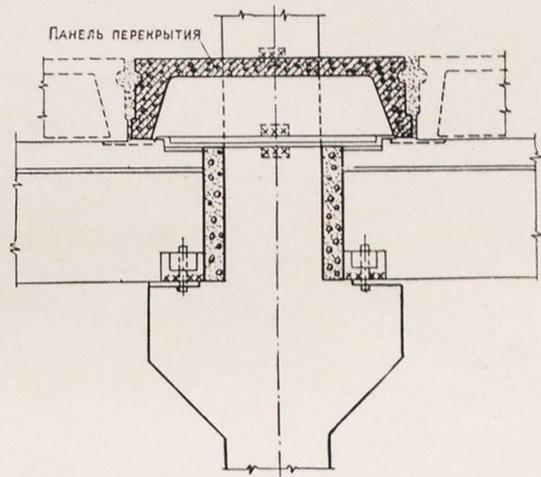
Конструкция узла перекрытия по проекту Гипротиса
